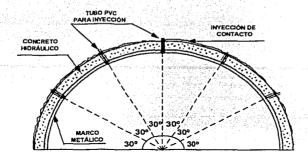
Inyección de contacto entre el concreto hidráulico y el perfil excavado del túnel.
